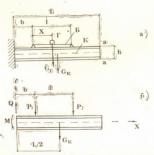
Қ определению наименьшего веса груза, вызывающего разрушение железобетонной консоли
